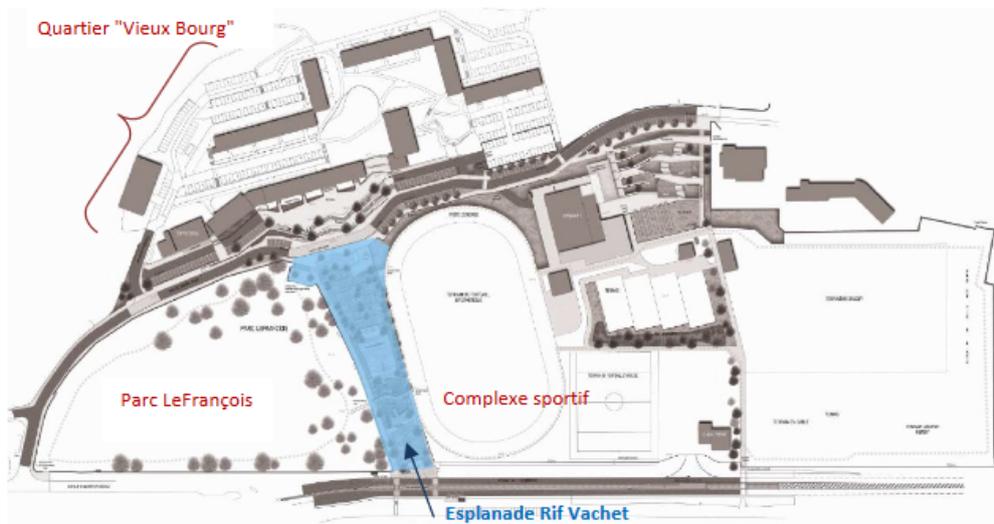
Plan de situation de l'esplanade Rif Vachet
